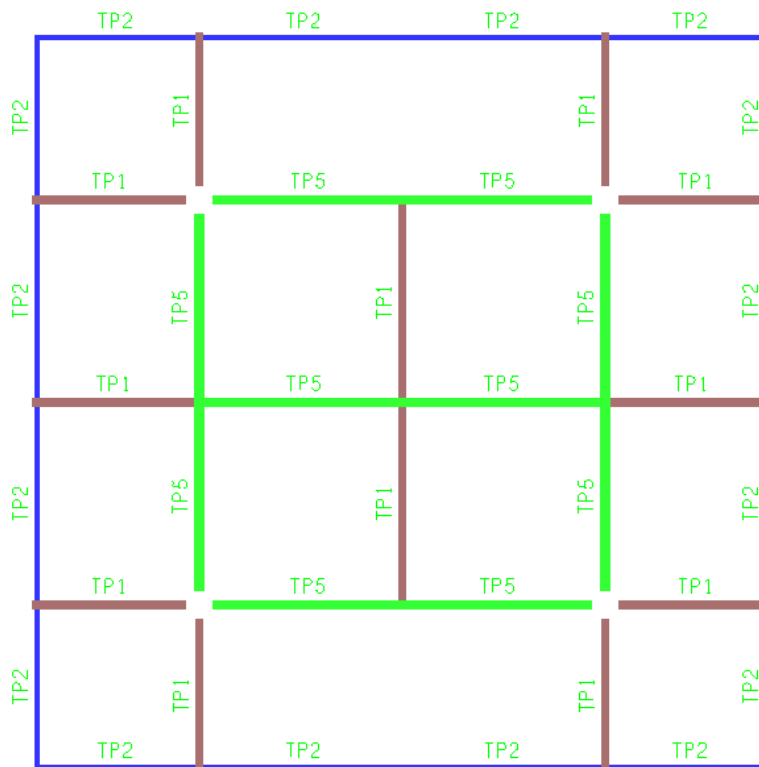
Elementi orizzontali a sezione aperta e boxata - impalcato Quota 32 m (copertura)
